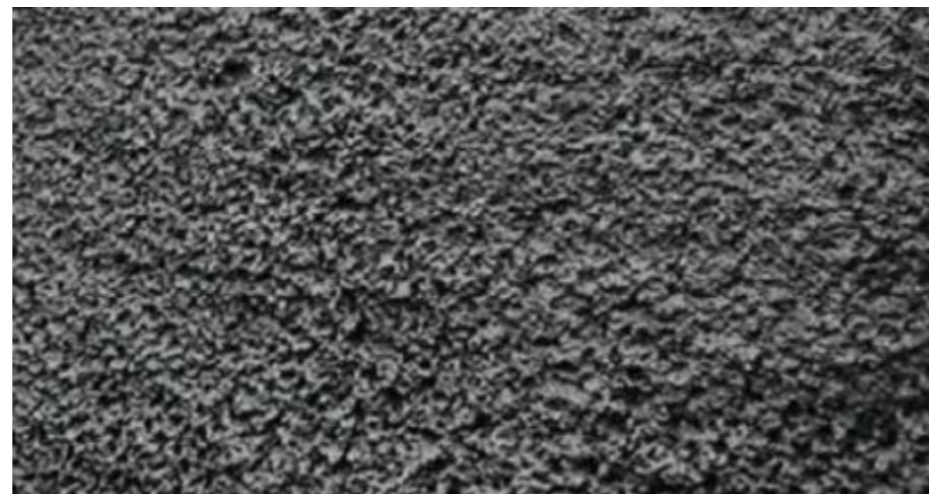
Textura de hormigón proyectado que deja la boquilla. (ICH, 2018)
